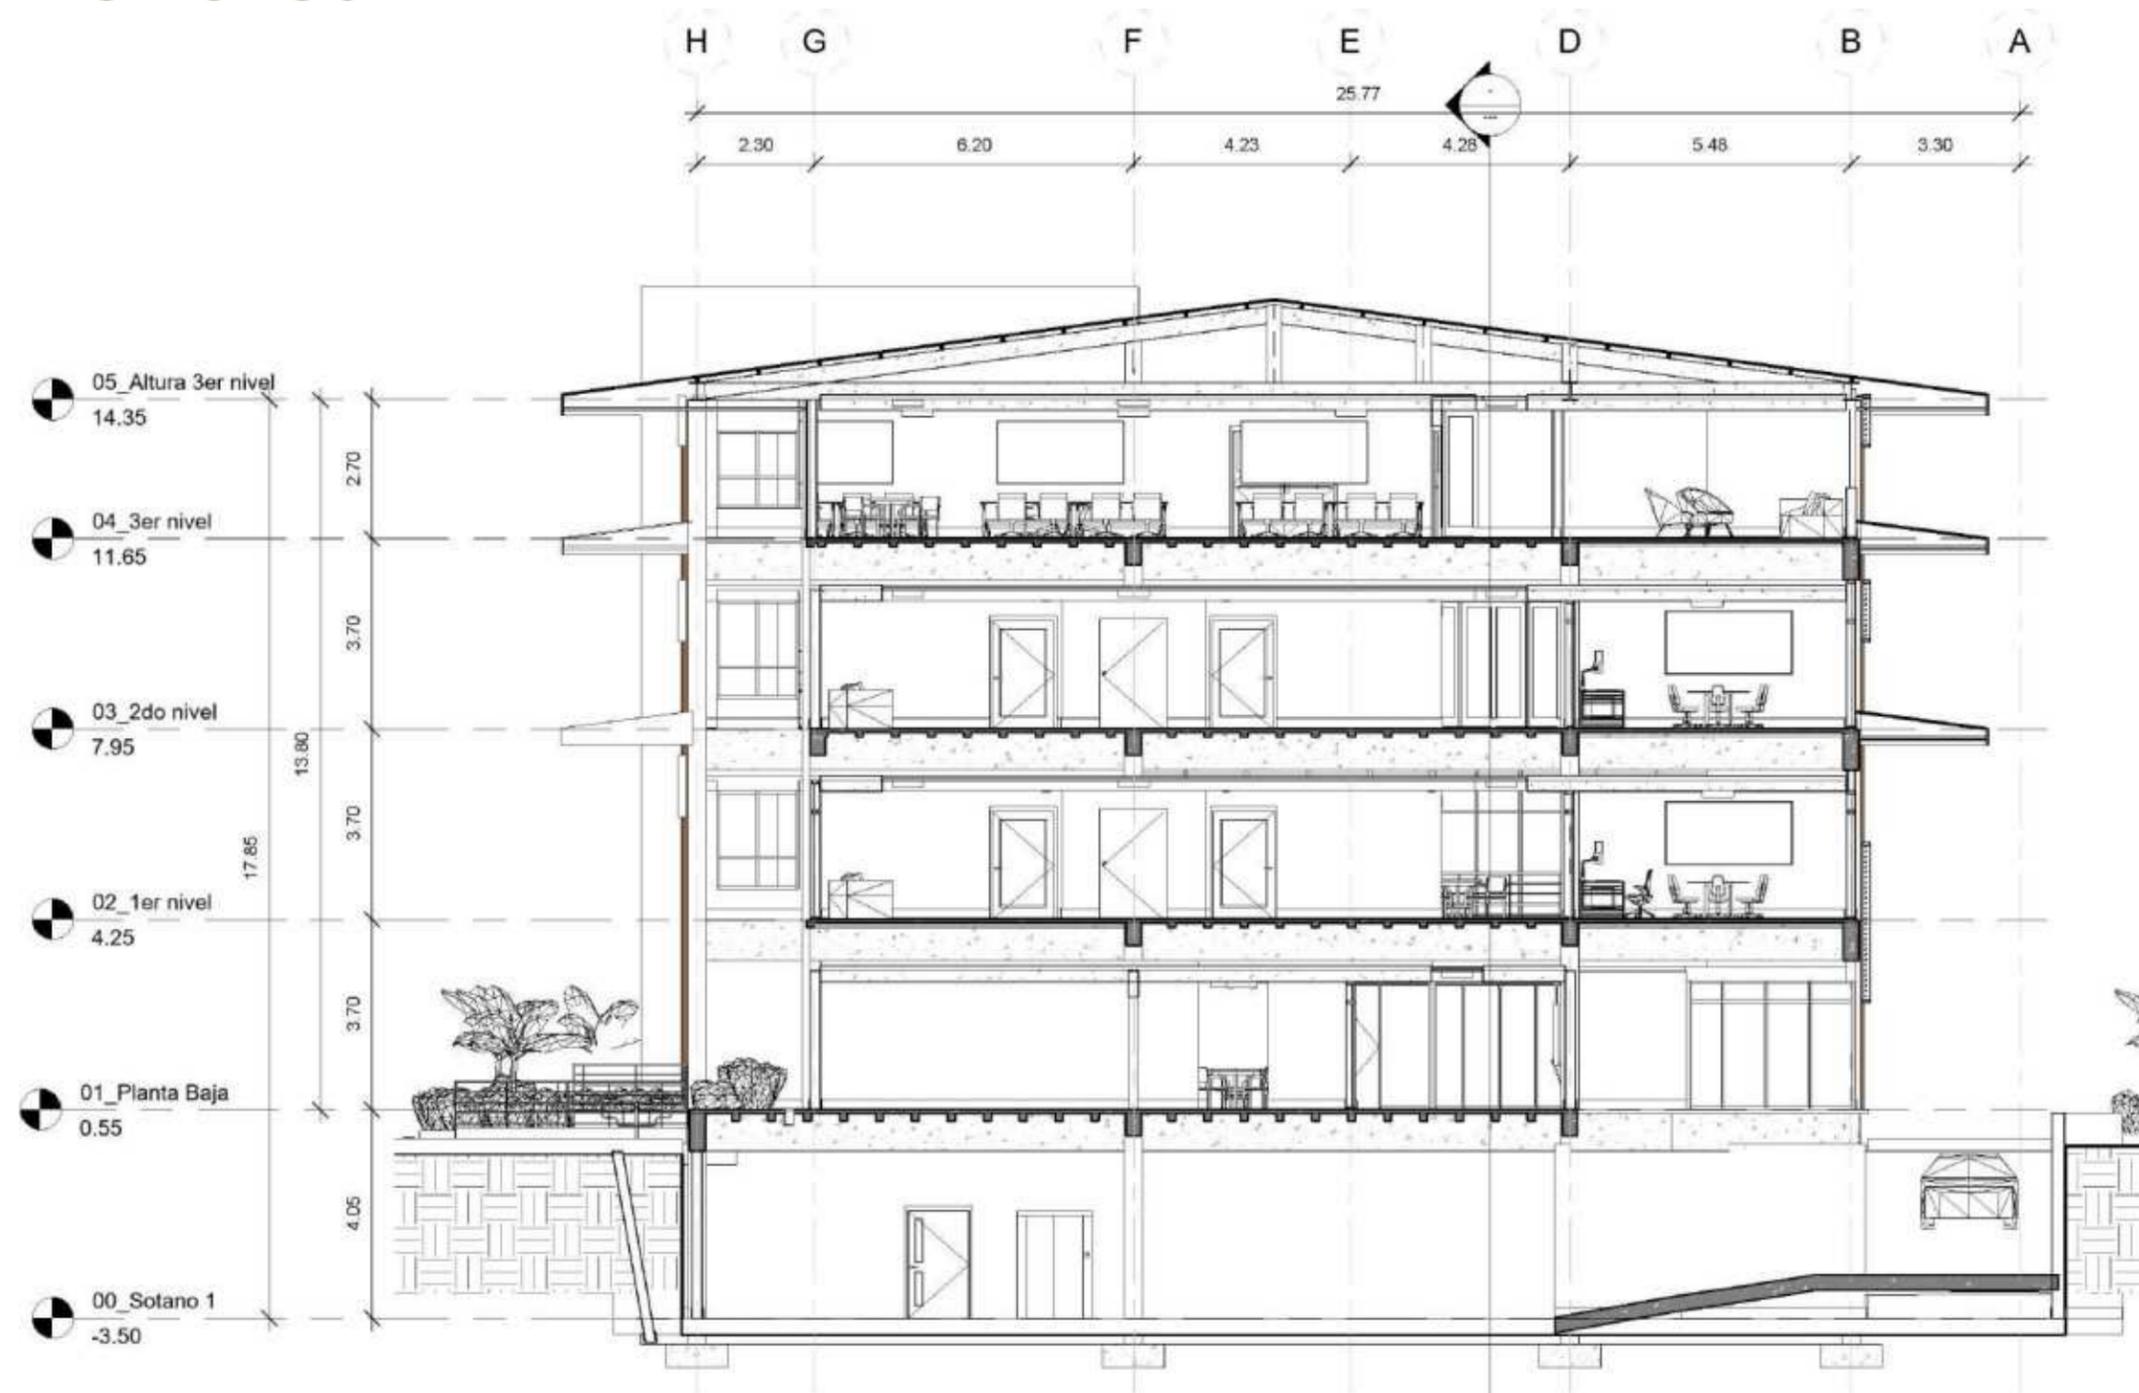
Sección arquitectónica- Autoría propia (2023)
